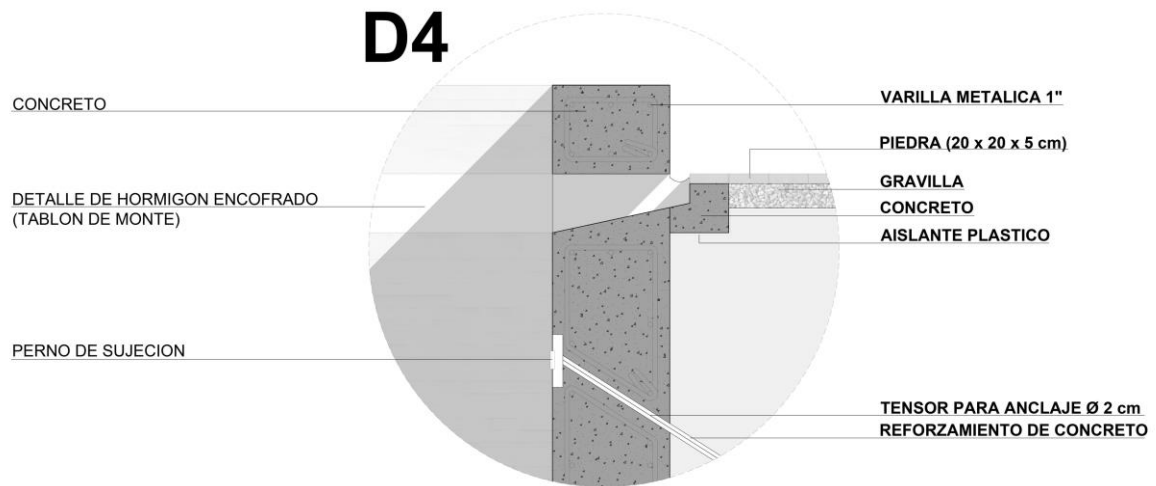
Detalle 4. Corte por fachada 1. Elaboración propia.
